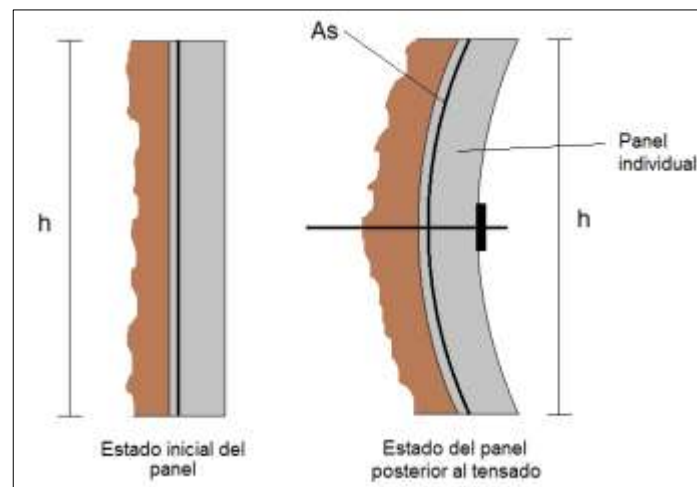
Esquema de proceso constructivo de muro anclado excavado por paños y por niveles. Fuente: Lección 19 - Muros de sótano. Técnica constructiva. Impermeabilización y drenaje. Escuela Politécnica de Cuenca - Arquitectura Técnica. S.f. Pág. 19.
